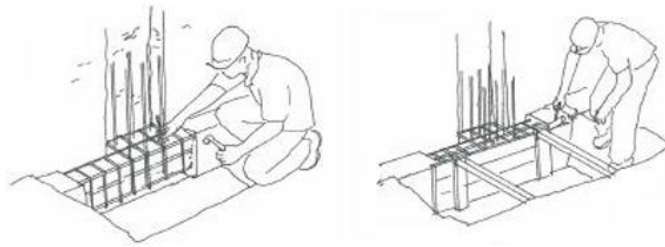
Trabalhos de colocação de armadura e de cofragem (11).
